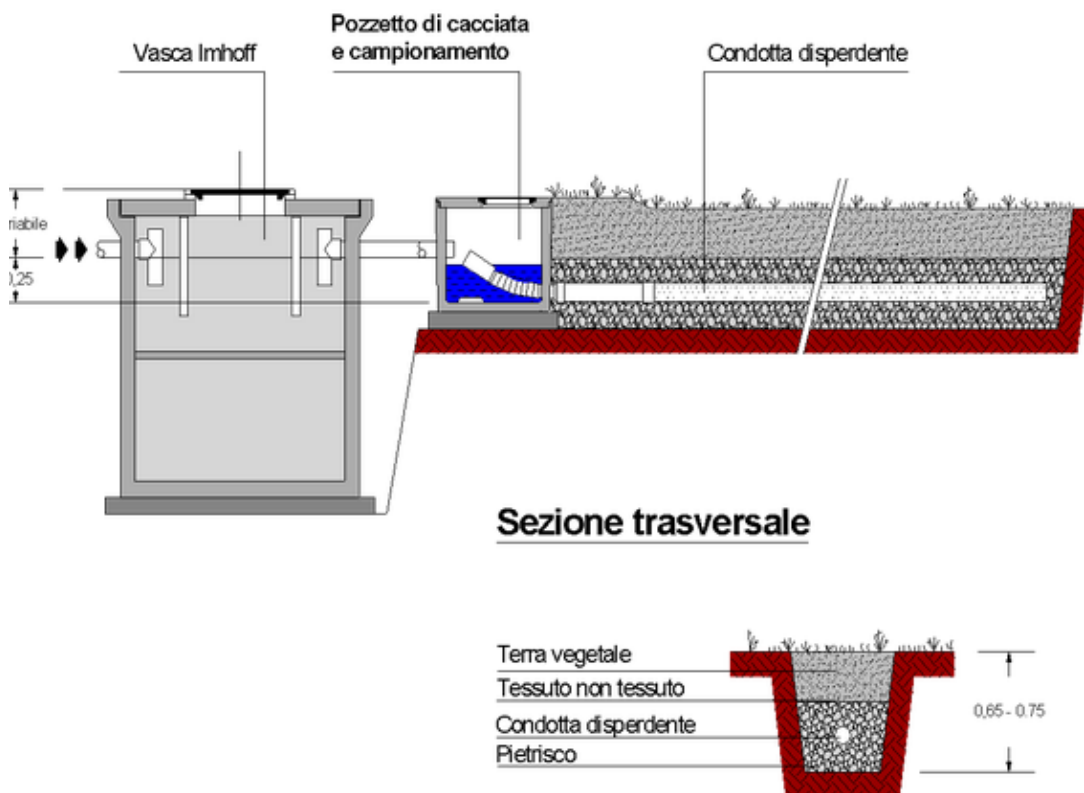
Dettaglio impianto di depurazione vista planimetrica
